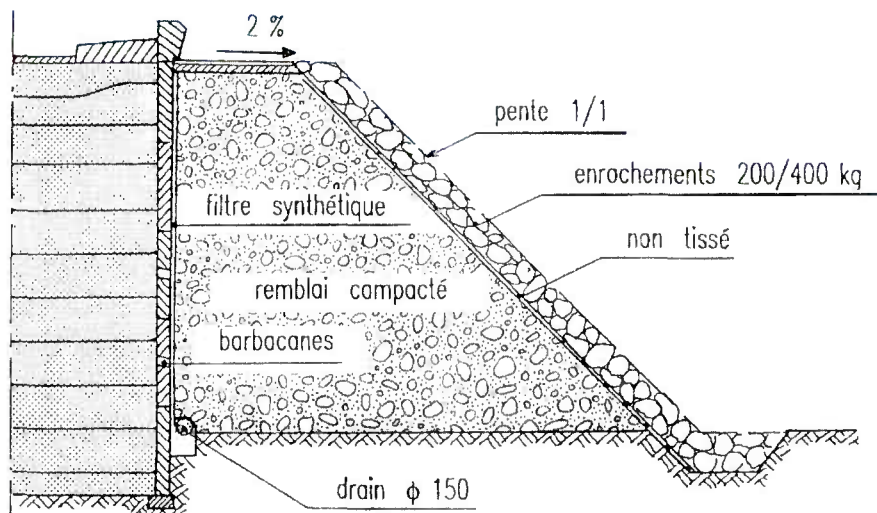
Confortement d'un mur en terre armée par remblai de butée
